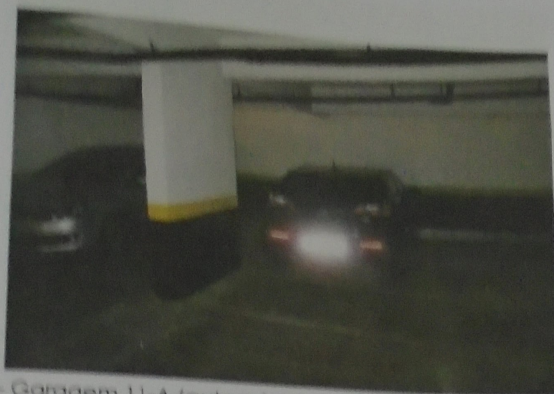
Garagem 11-A (automóvel escuro) à direita do pilar - 1º subsolo
